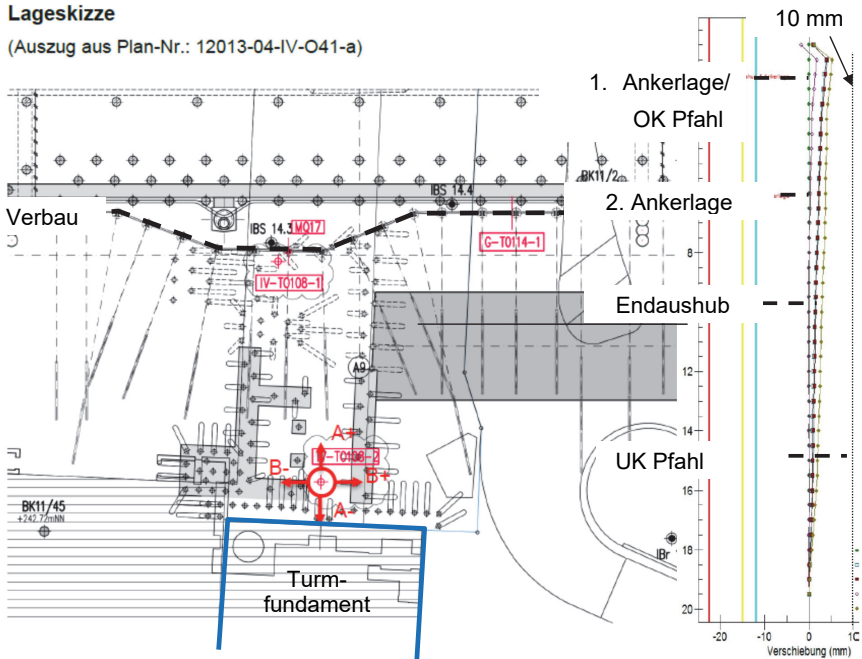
Lageplan mit Lage der Inklinometer und Messwerte bei Endaushub
